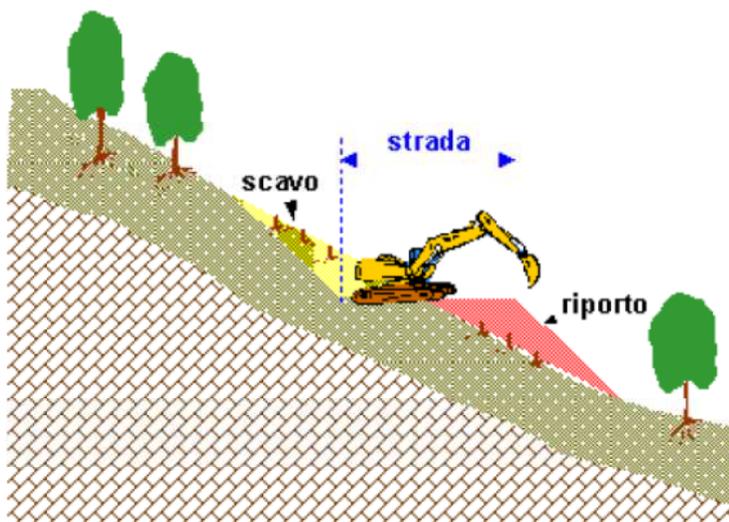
Schema di realizzazione pista di cantiere Tipo II - Compensazione scavo/riporto.
